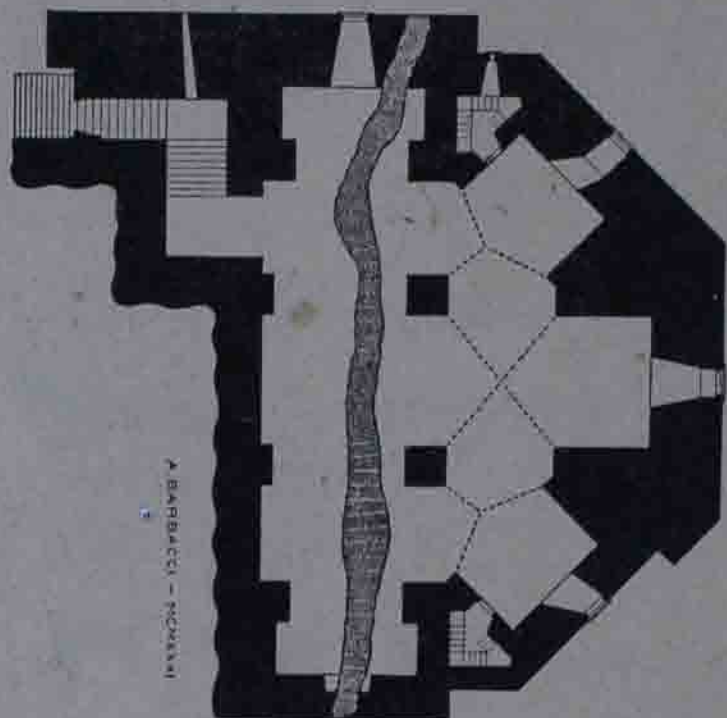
, Pienza, Unterkirche des Doms; Grundriß mit dem Erdriß.
